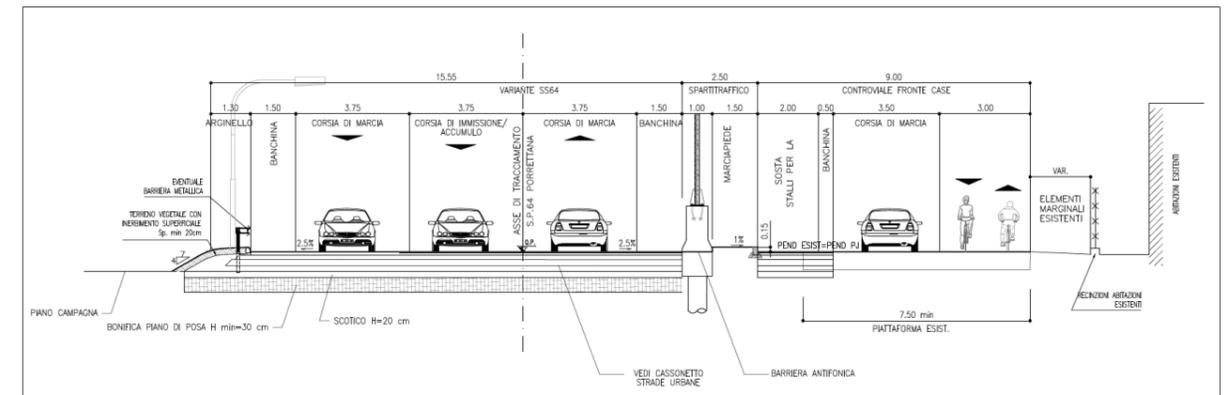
sezione stradale tipo variante SS 64 Porrettana in località Case Nuove³²
